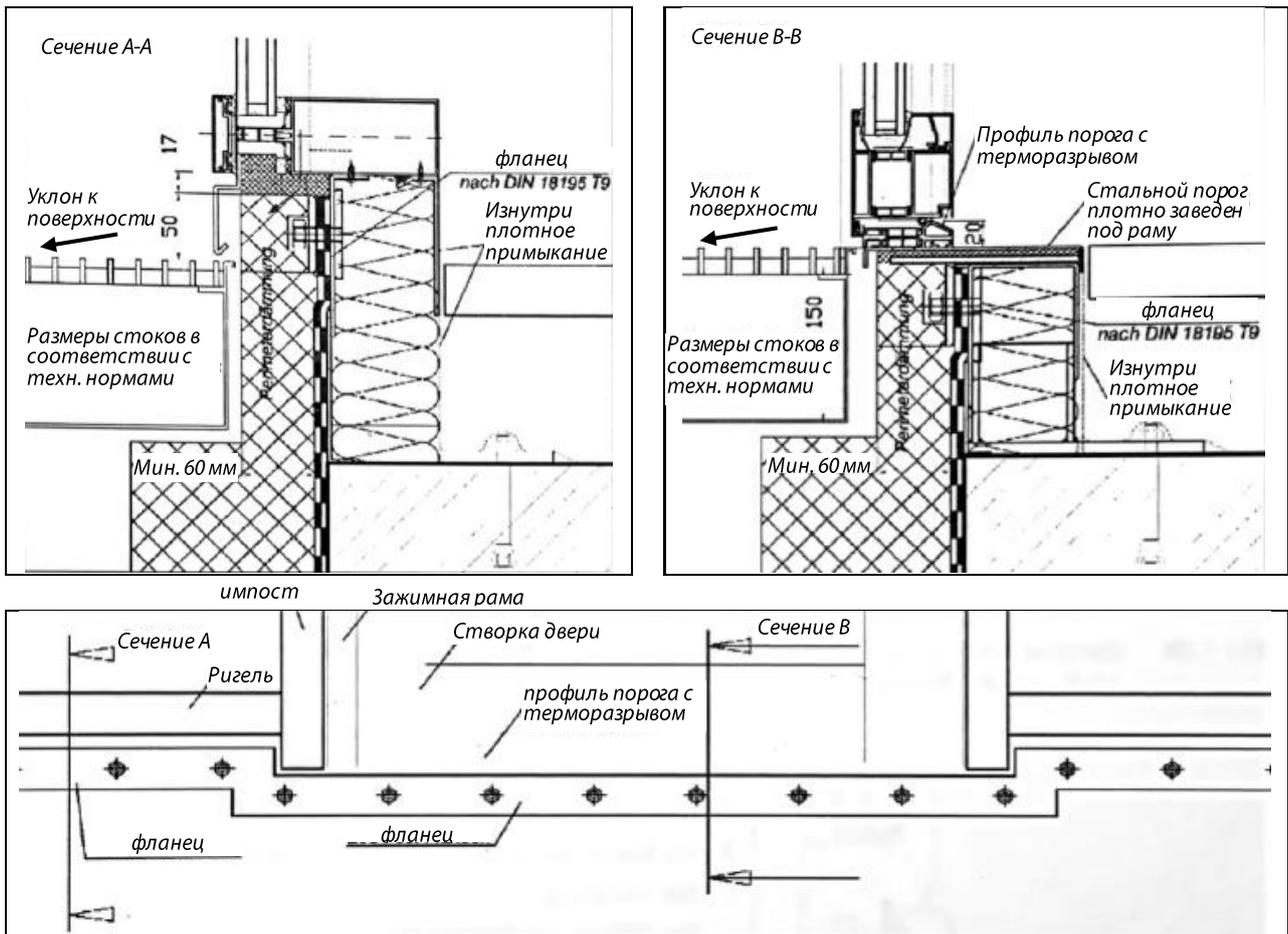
Пример подробного планирования конструкции: уплотнение узла примыкания с учетом инструкции по совмещенным кровлям и 20 мм порога на примере алюминиевого импостно-ригельного фасада с интегрированной входной дверью наружного открывания.
